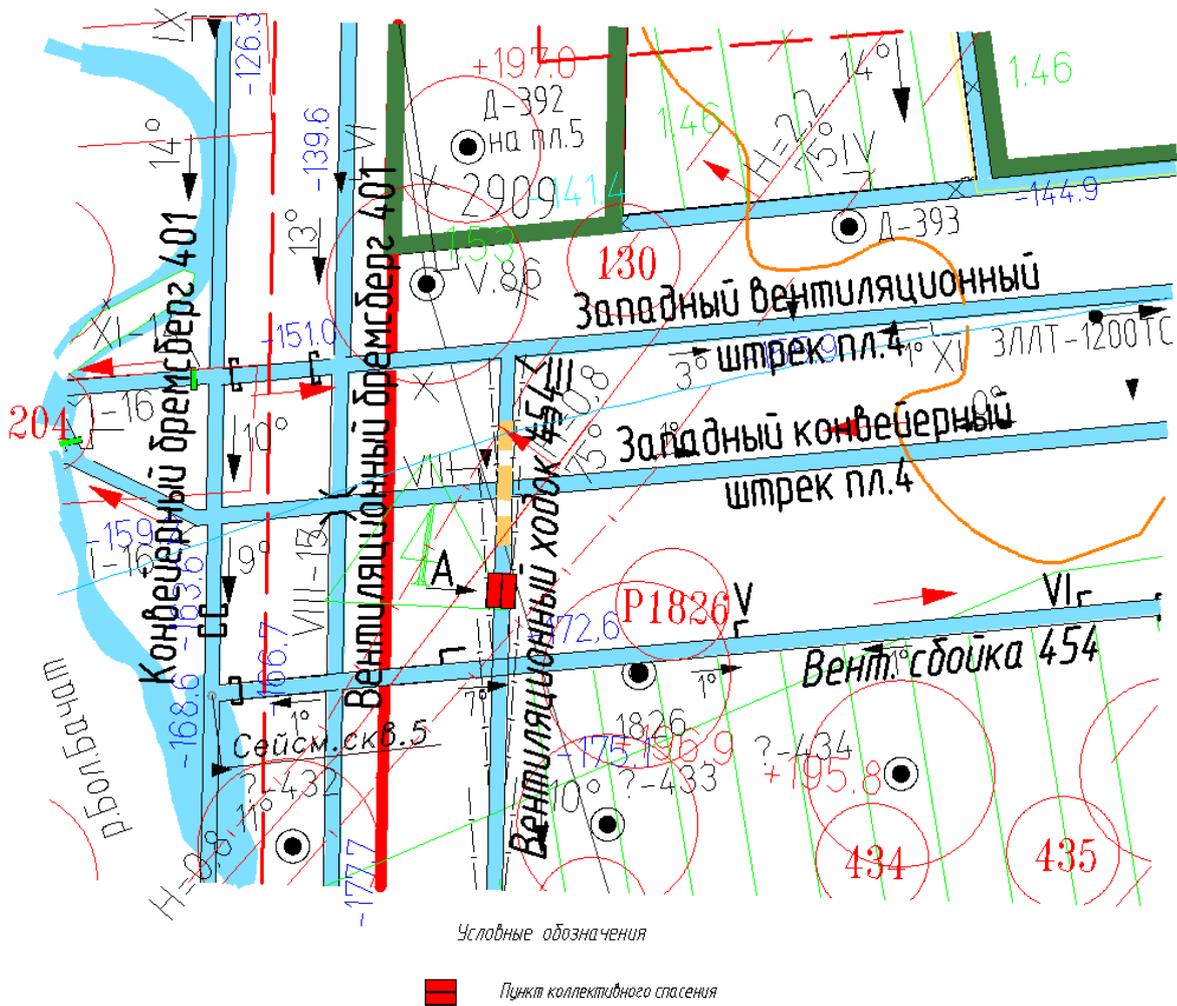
Выкопировка с плана горных выработок пласта 4 с указанием места размещения ПКС
